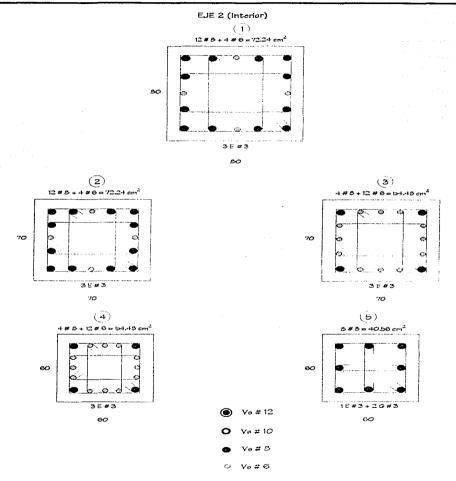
Tipos de armados de las columnas del eje 2, edificio de 7 niveles disciñado en la zona Ili
